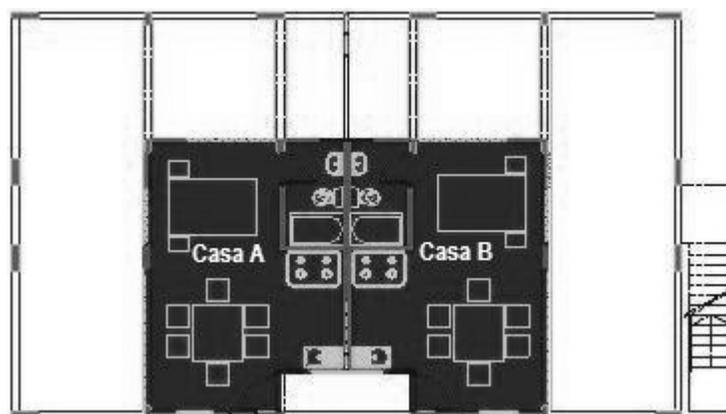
Planta Casas A y B. Zona Achurada superficie inicial.
